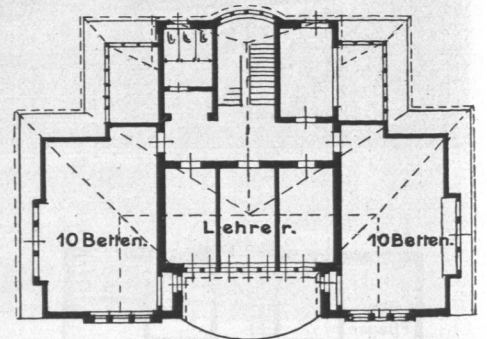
Irrenanstalt Friedrichsberg, Haus für jugendl. männliche Kranke, Obergeschoß, Grundriß.
